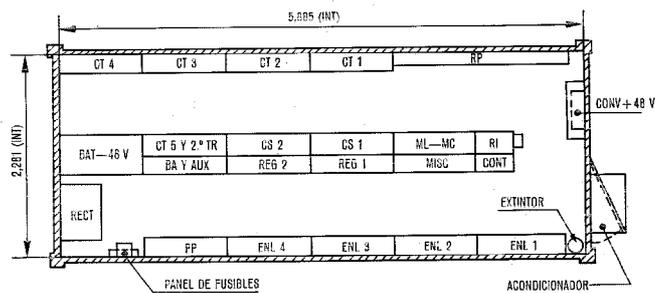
Central móvil de 700 líneas — Distribución en planta.
